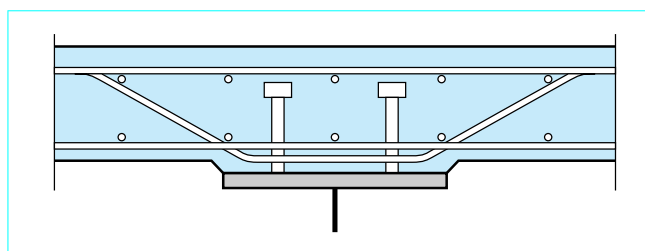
Dalle en béton. Appui et connexion sur poutre
